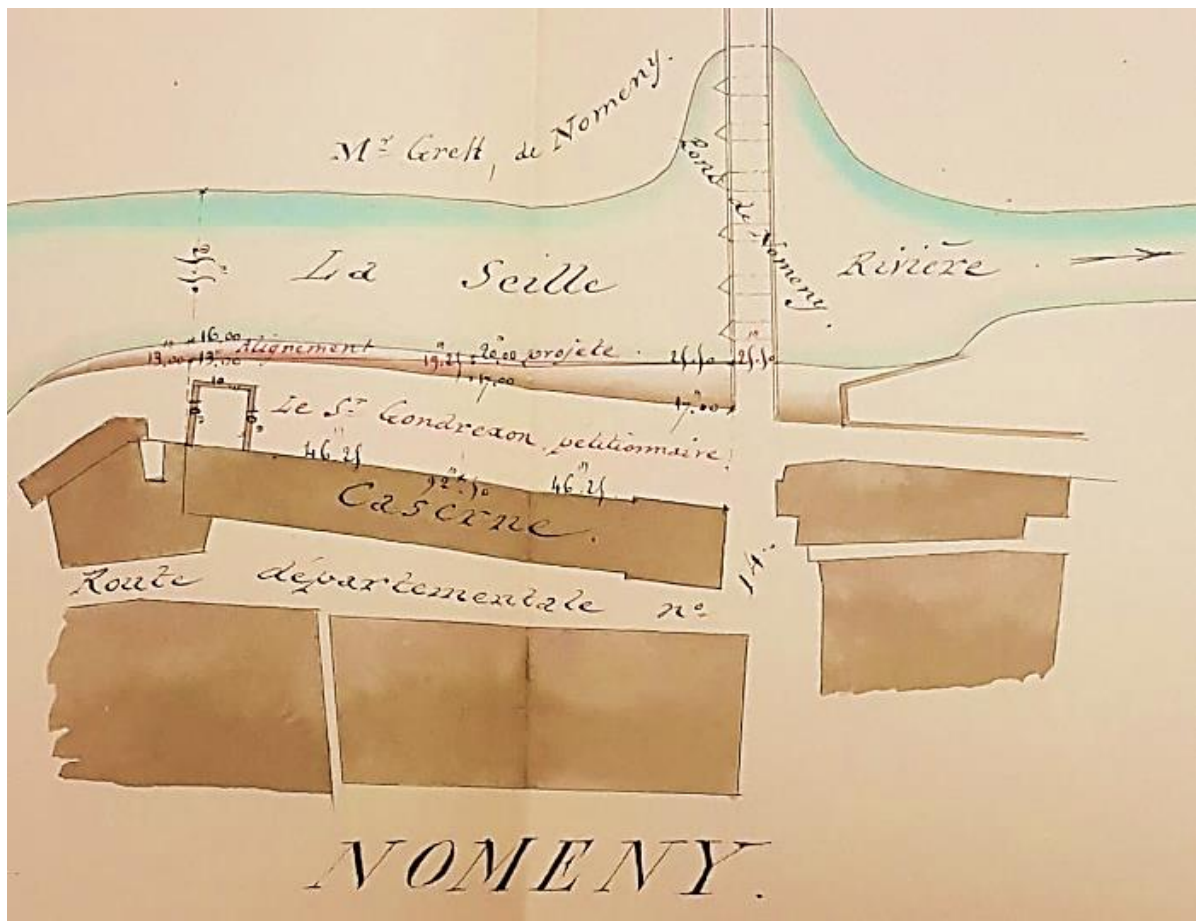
Extrait du plan de la rivière Seille aux abords du pont de Nomeny. Plan réalisé par le service des Ponts et Chaussées du département de la Meurthe dans le cadre d'une demande d'alignement. On y observe en rouge, en rive droite de la Seille, l'alignement prévu. (Source : AD54 - 3S112)
